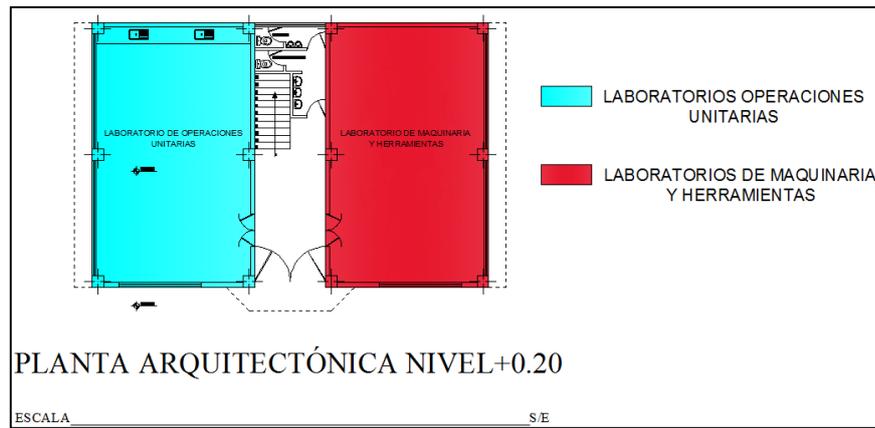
Laboratorios de Industrial en la planta baja del Bloque D
